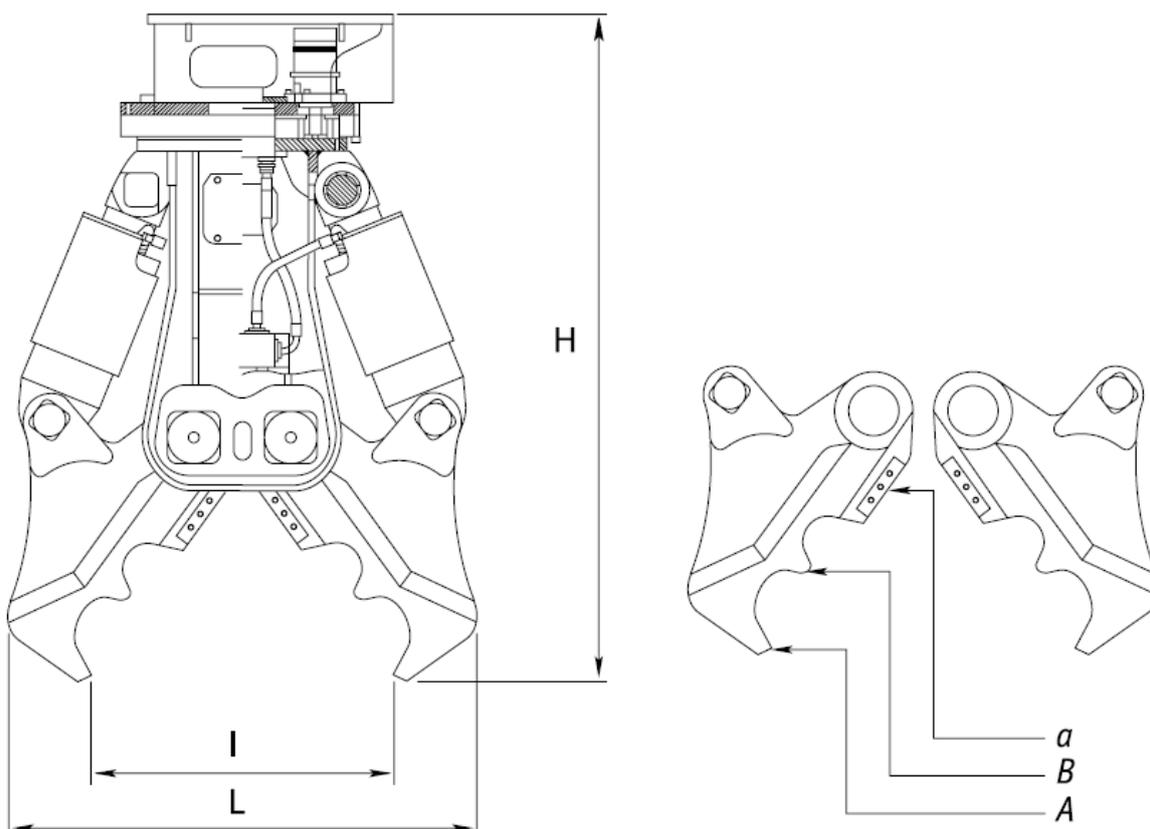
Конструктивная схема гидроразрушителя (мультипроцессора) Delta
